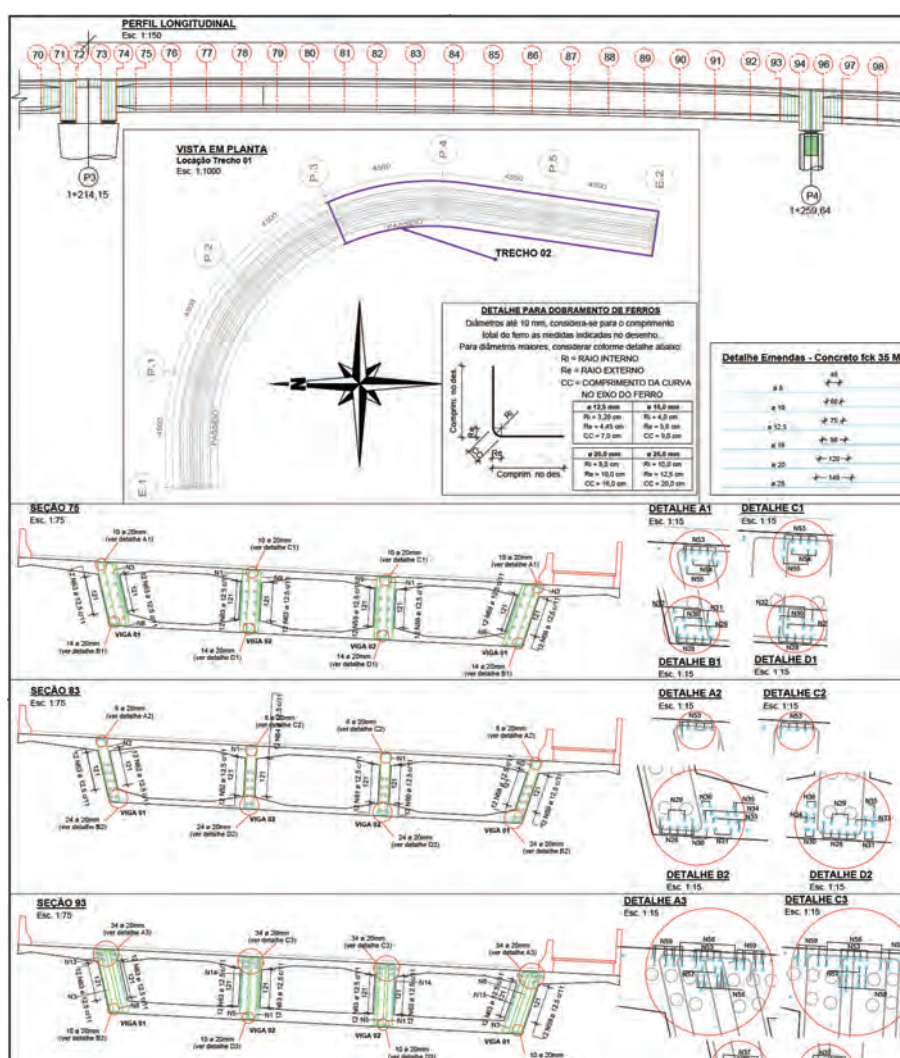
Exemplu plan cofraj și poziționare teci toroane
